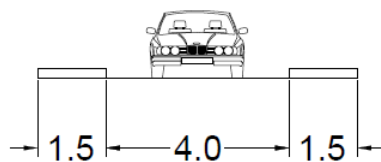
Sección Transversal Av. Juan Pablo Duarte (1 carril, una vía). (Fuente: Elaboración Propia).
